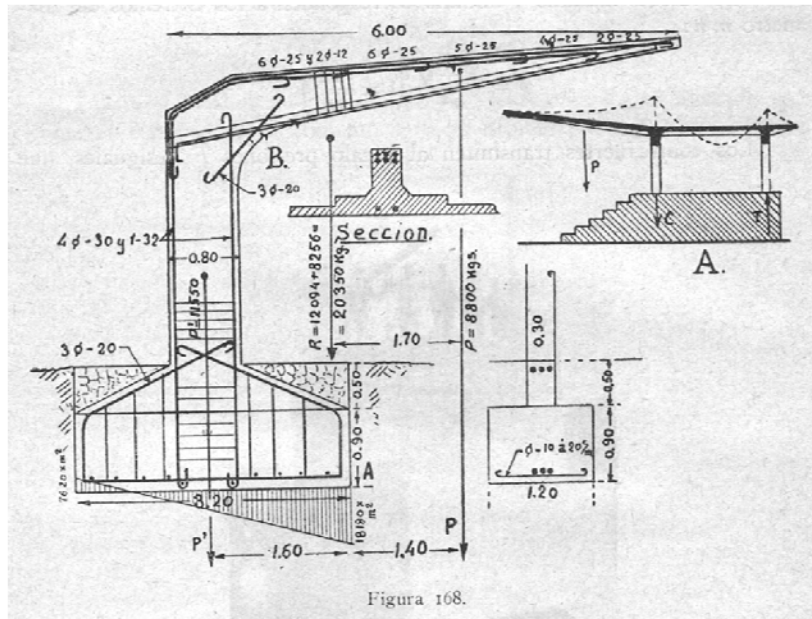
Sección del armado de una cubierta proyectada por el arquitecto Tejero y el ingeniero Urdaspal.
